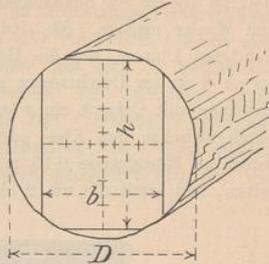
Beschlagen. Der rechteckige Querschnitt eines Balkens bzw. Bauholzes mit Baumkante
